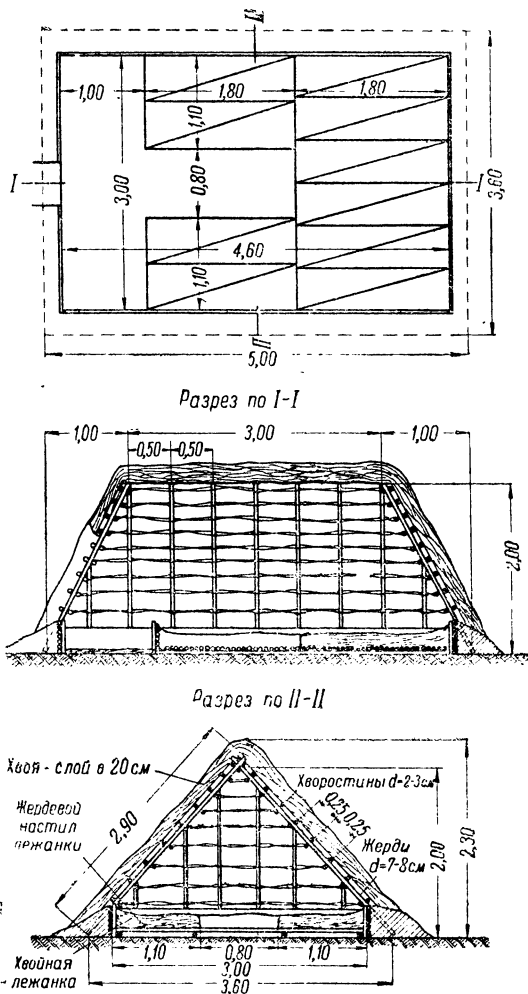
Прямоугольный четырехскатный шалаш на 10 человек
